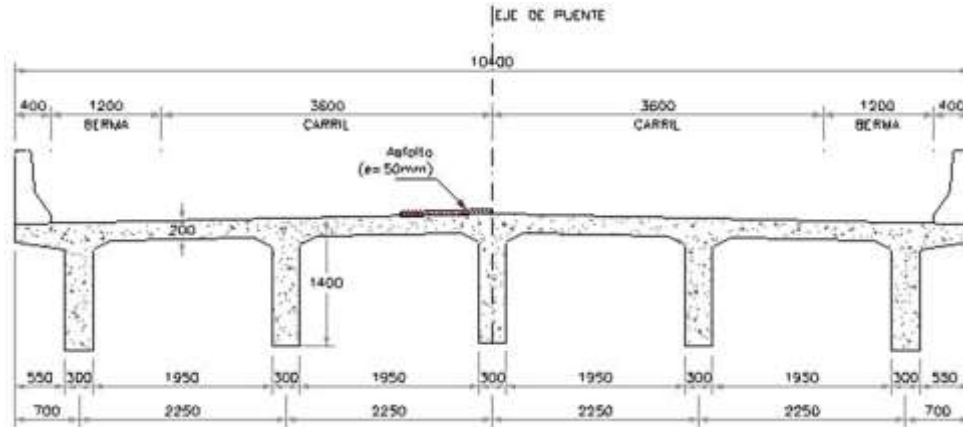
Sección Típica de vigas "T" en las zonas de momento positivo de la Superestructura para los Puentes estudiados.
